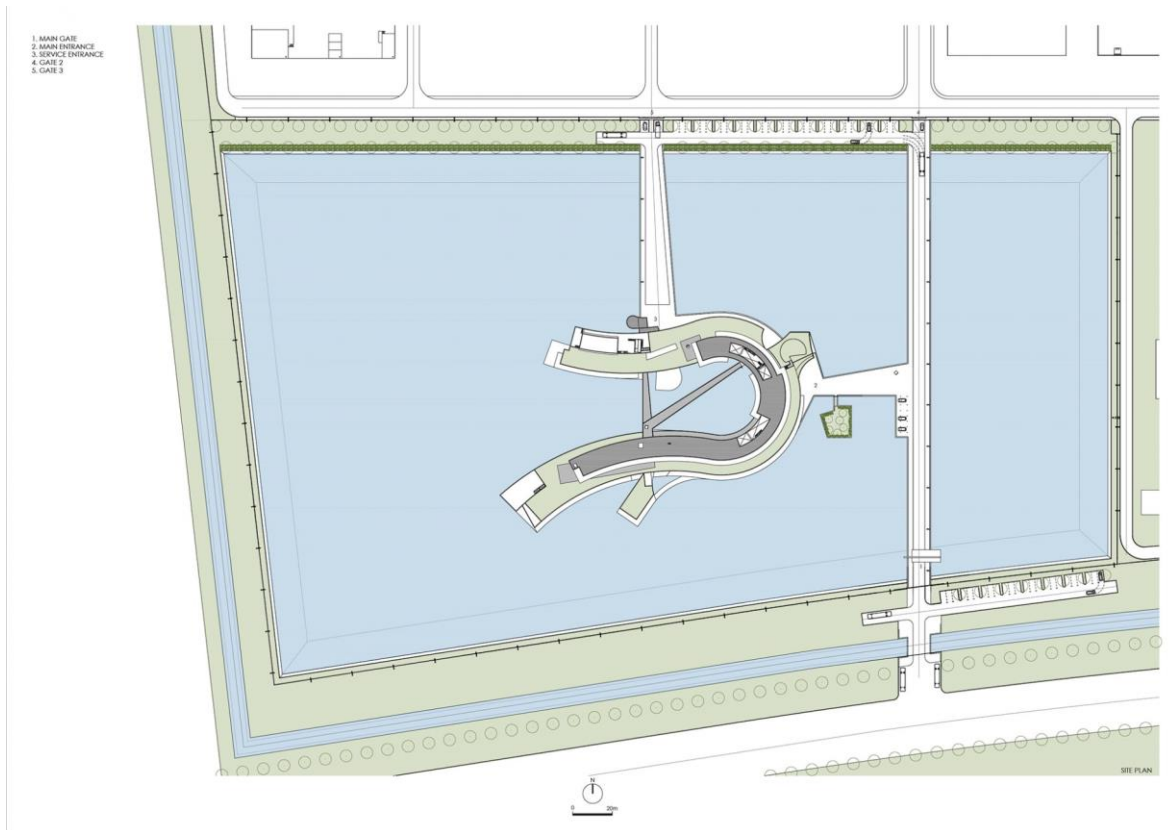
| Edifício sobre a água, Planta de Implantação (Carlos Castanheira)
